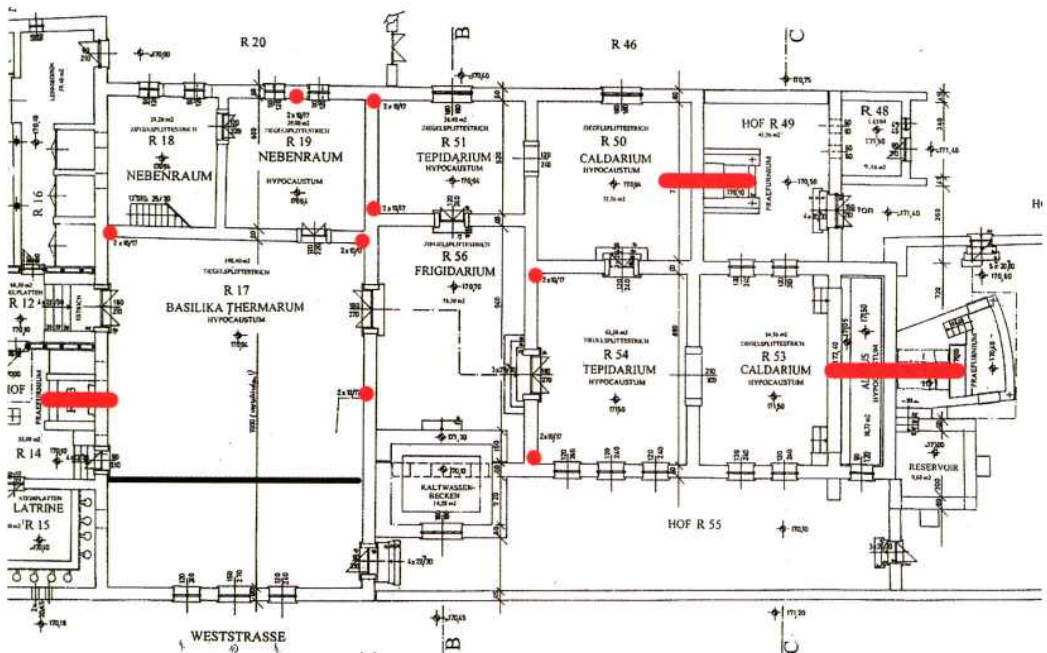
Grundriss des beheizten Teils der Thermen, so wie er ursprünglich geplant war. Die roten Striche markieren die Praefurnien, die roten Punkte die Abzüge. – Floor plan of the heated rooms of the thermae as initially planned. Red lines marking praefurniae, the red points flues.
